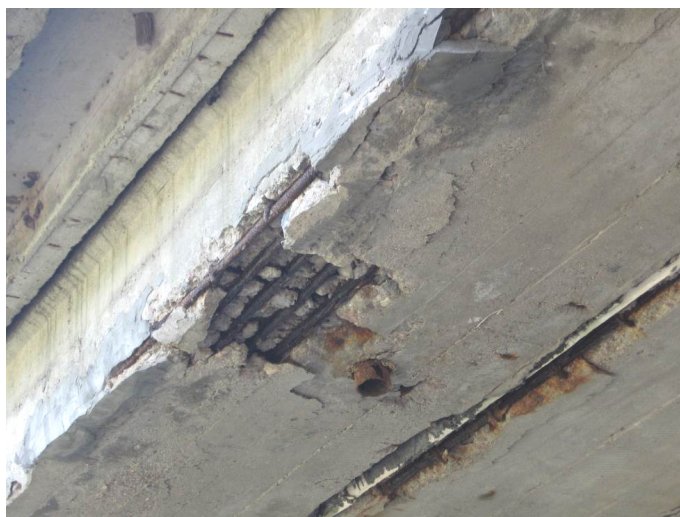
Мост через р. Рита на а/д Р-17 Брест – гр. Украины: разрушение бетона крайних плит в пролете № 4, коррозия стержней рабочей арматуры
